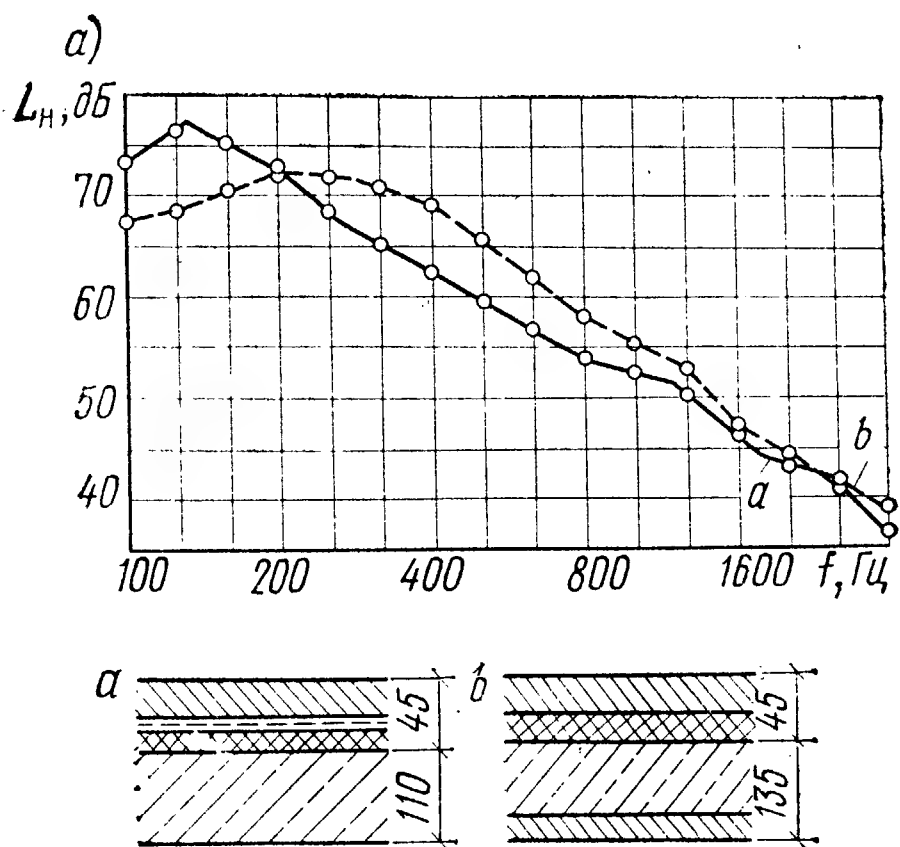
Звукоизоляция конструкций перекрытий по железобетонным плитам [3]
